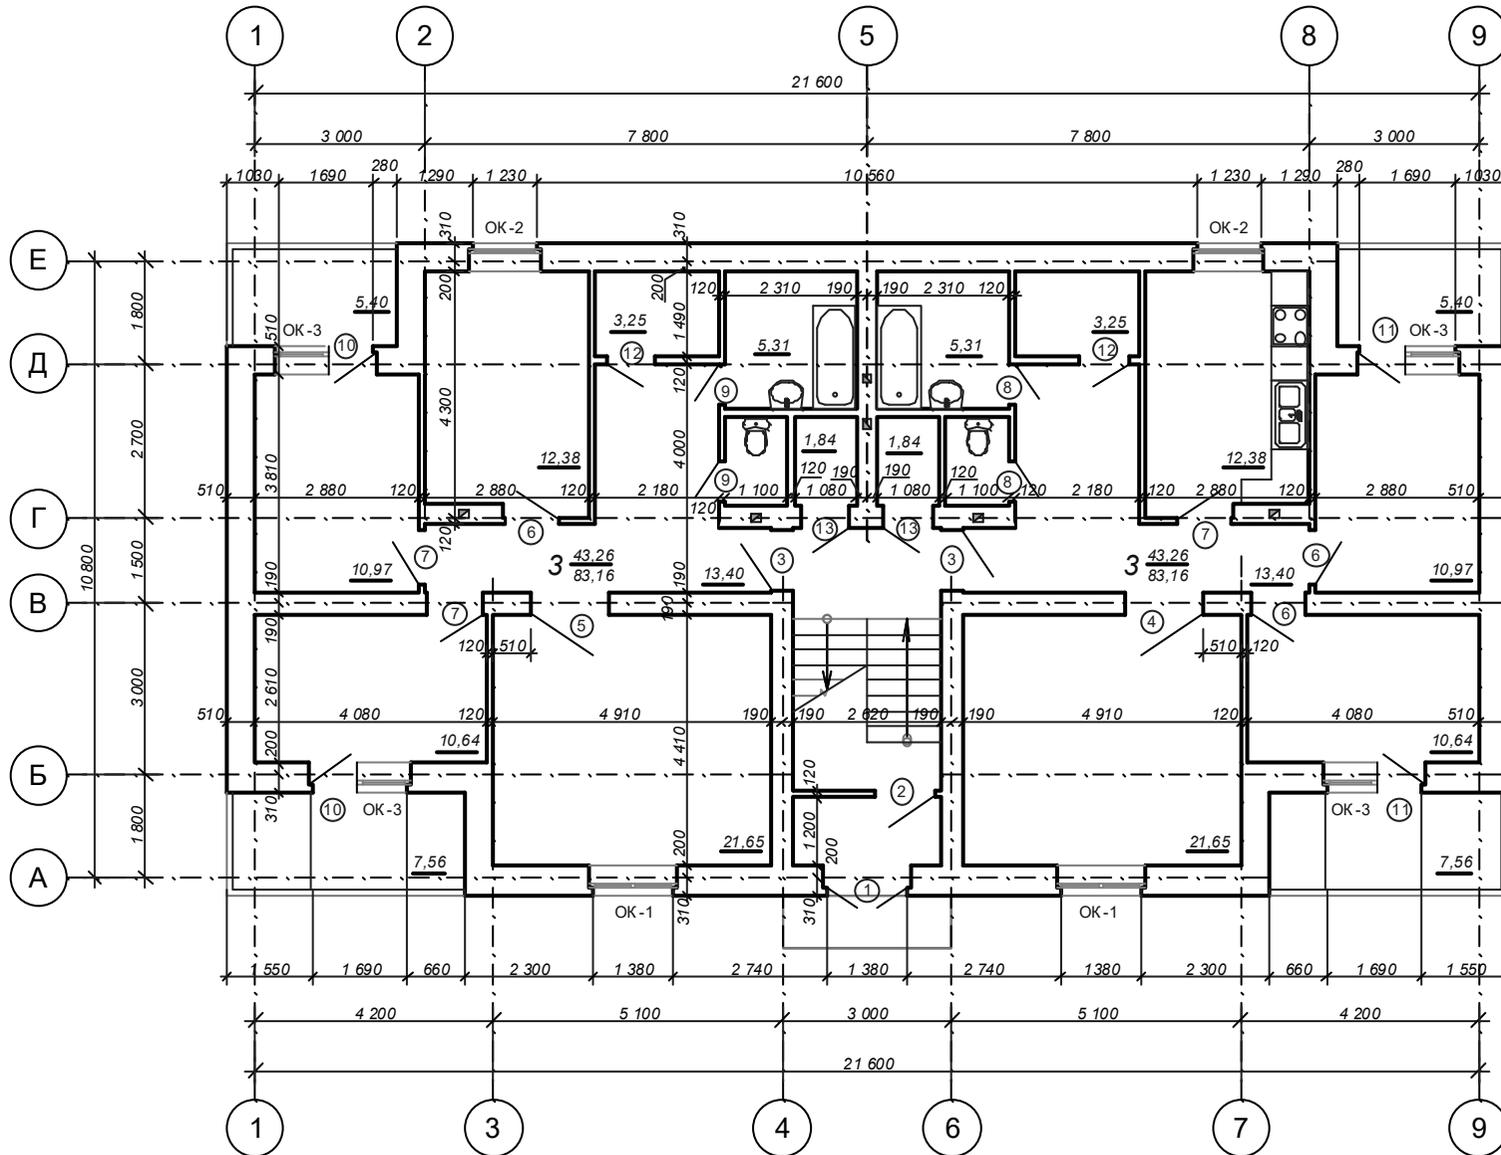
Пример оформления плана 1-го этажа жилого дома со стенами из мелкогабаритных элементов
